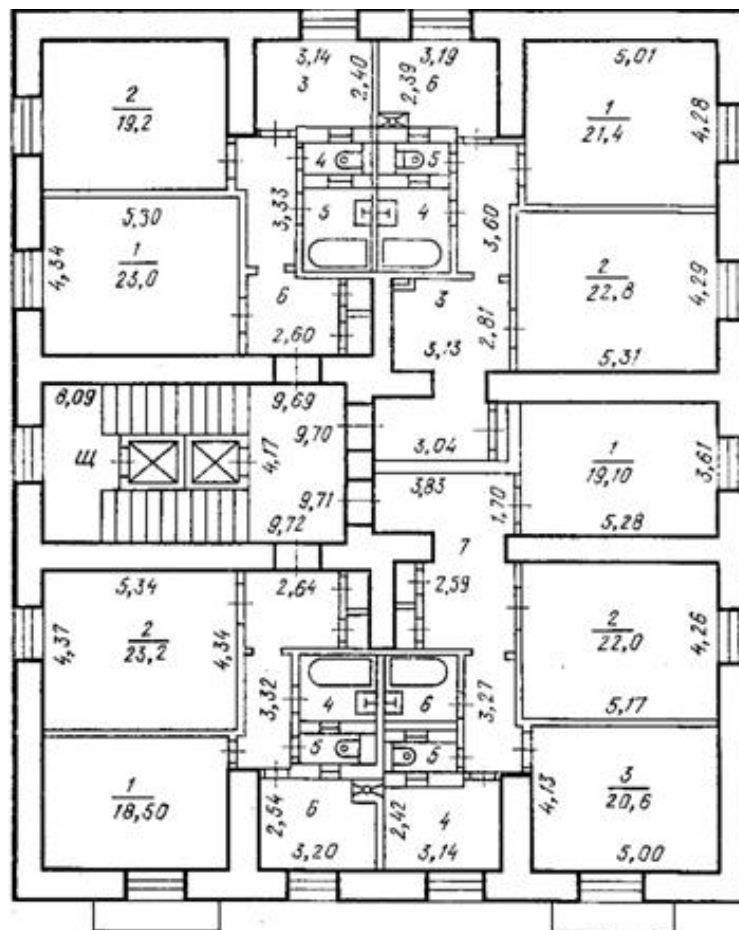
Фрагмент плана этажа по проекту капитального ремонта с перепланировкой жилого дома
